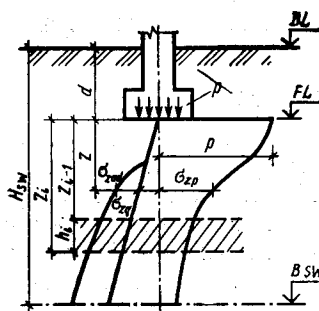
Расчетная схема для определения подъема основания при набухании грунта:
